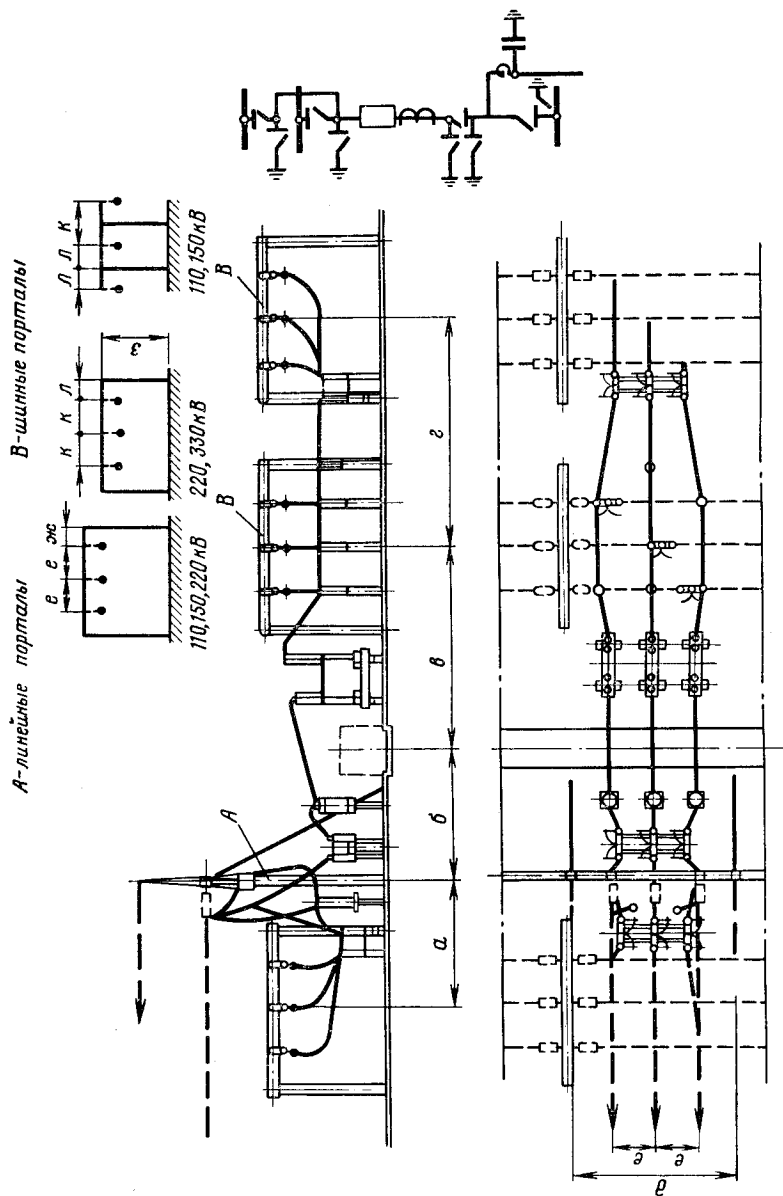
Компоновка ОРУ 110—220 кВ для схемы с двумя рабочими и обходной системами шин
